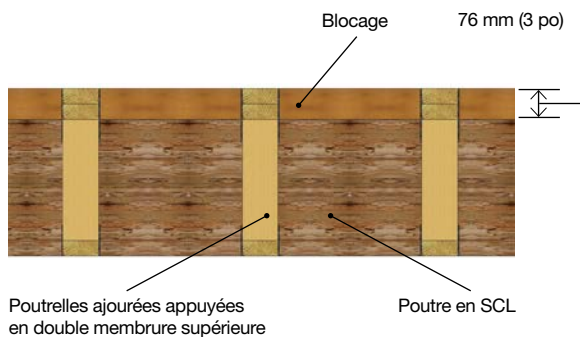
• Poutrelles appuyées par la semelle supérieure
